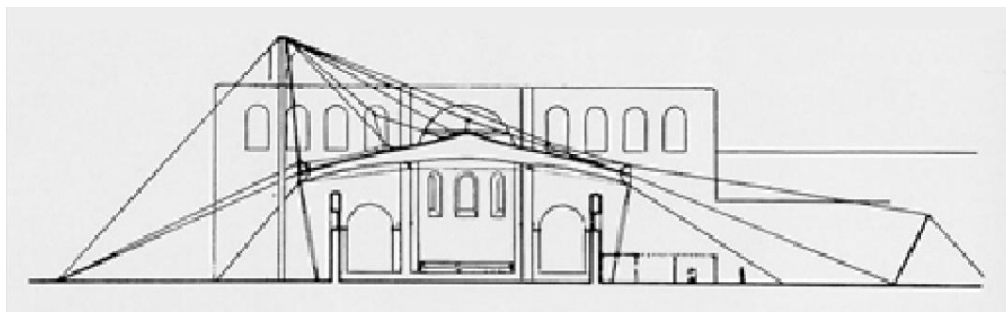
Prospetto principale della copertura della piscina al Boulevard Carnot di Parigi,
